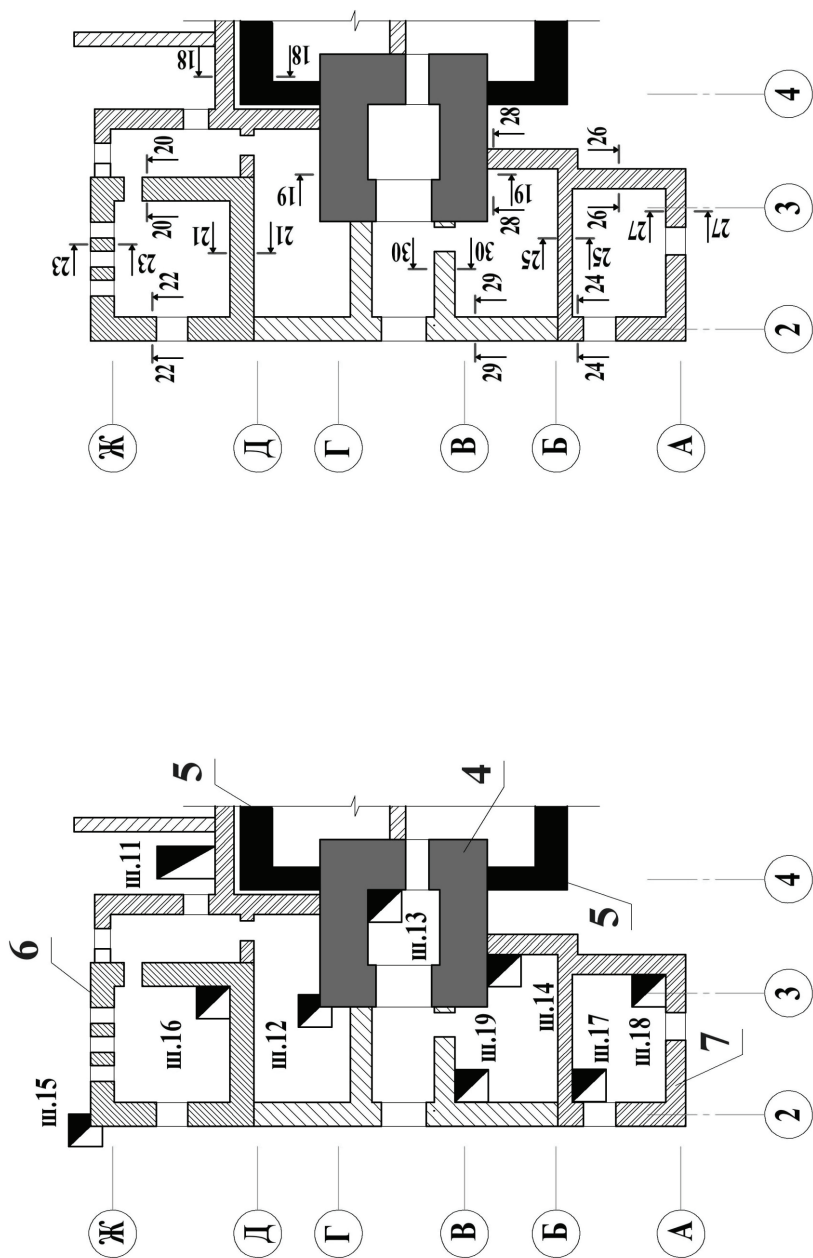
Схемы расположения шурфов и сечений фундаментов
